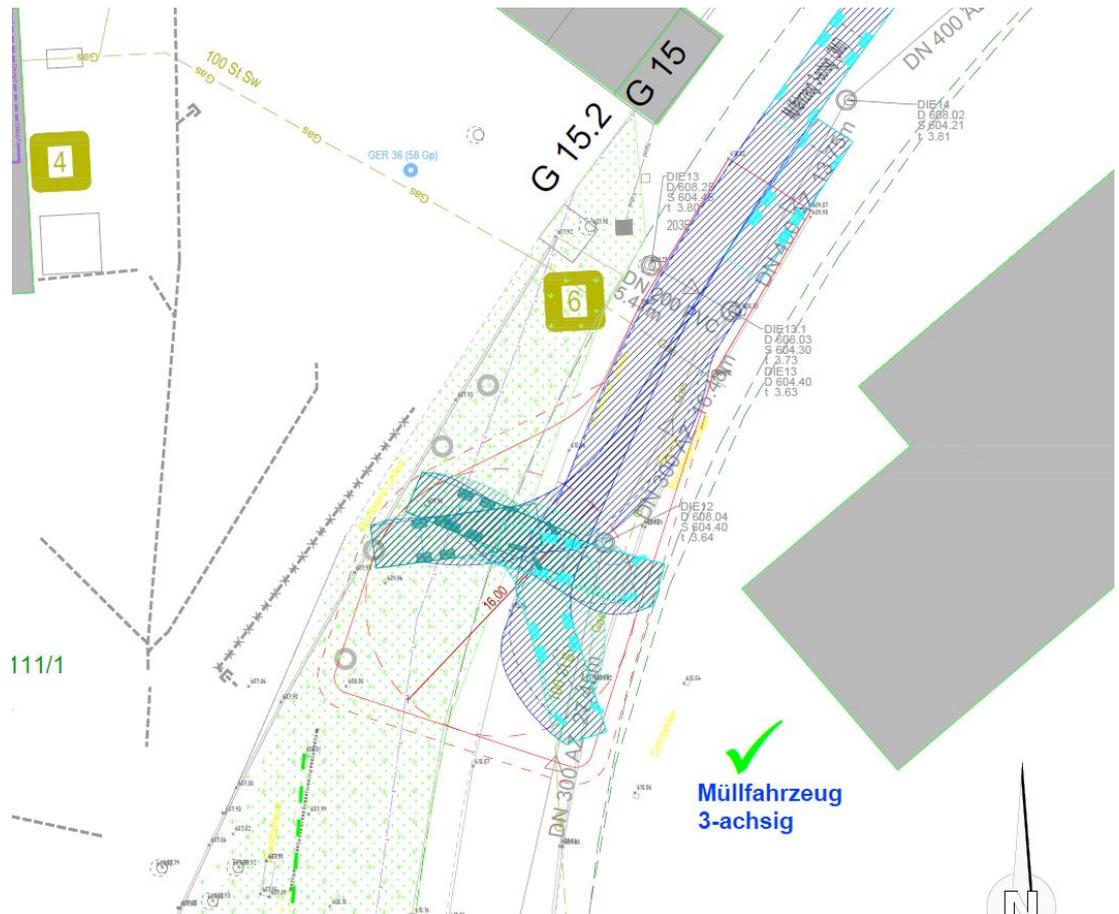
Planung Wendehammer Dieselweg, ohne Maßstab; ing München-West GmbH, Projekt Nr. 197055, Anlage Plan Nr. -/20, 09.03.2023
